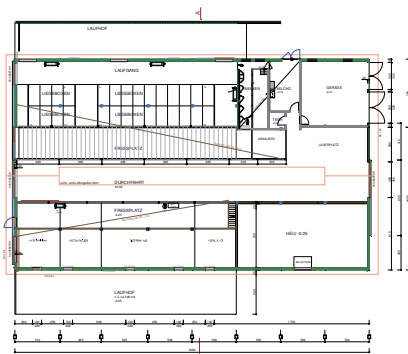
Grundriss, Neubau Laufstallhalle
